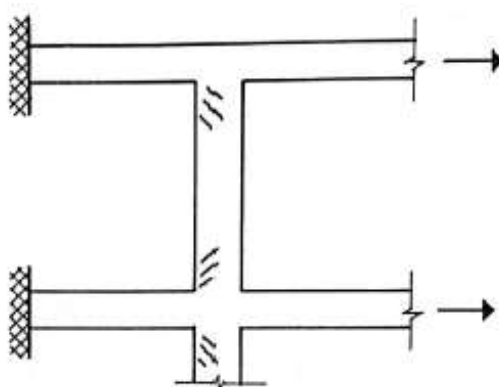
Pilar fissurado devido à movimentação térmica das vigas de concreto armado
